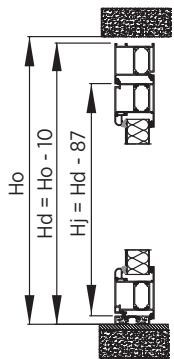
Montaggio in foro - sezione verticale - porta a un'anta - sistema MB86N ST.
